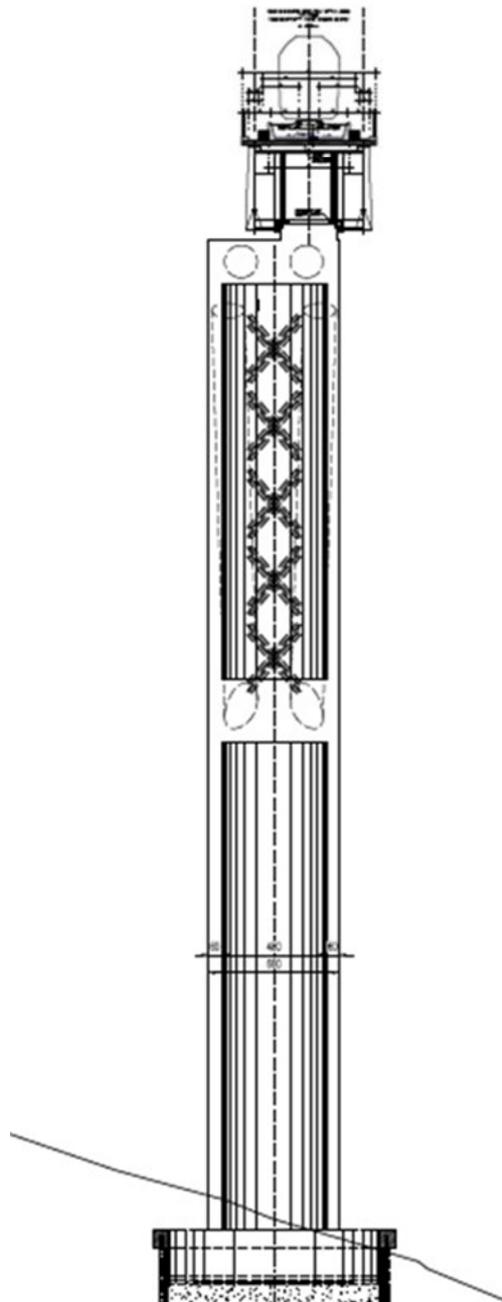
Fusto Pile – Sezione trasversale su pila
